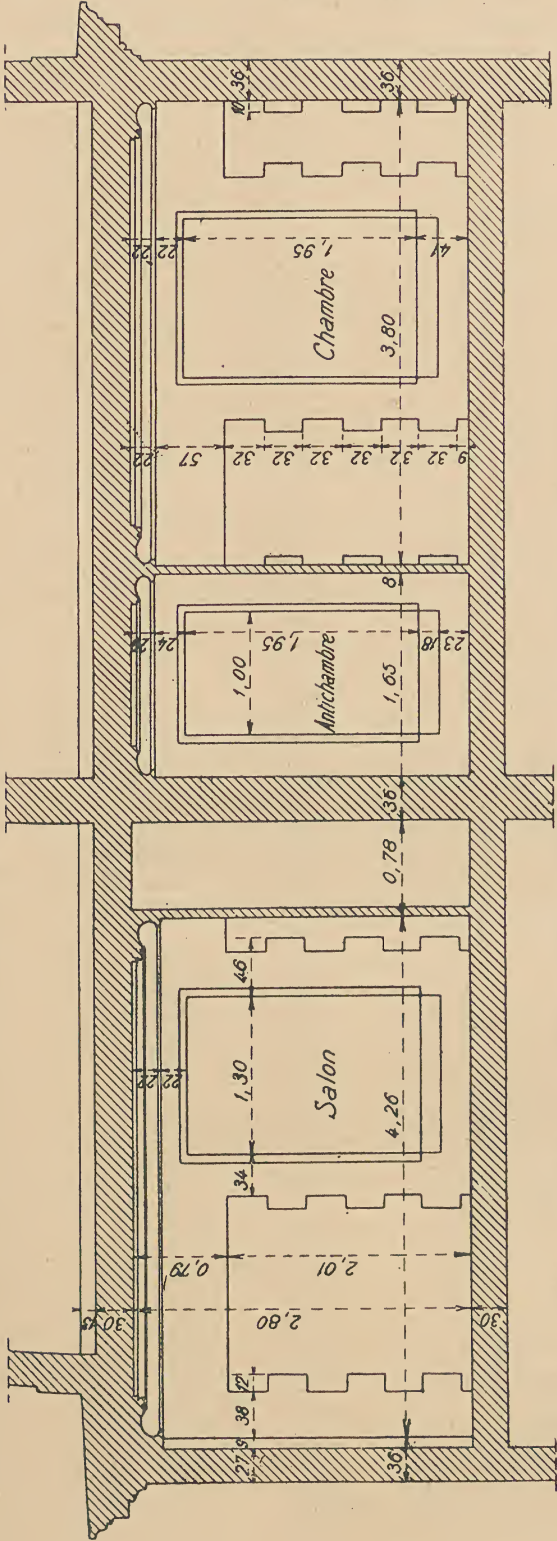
Élévation intérieure du mur de façade au 3<sup>e</sup> étage sur l'impasse du Cadran.
